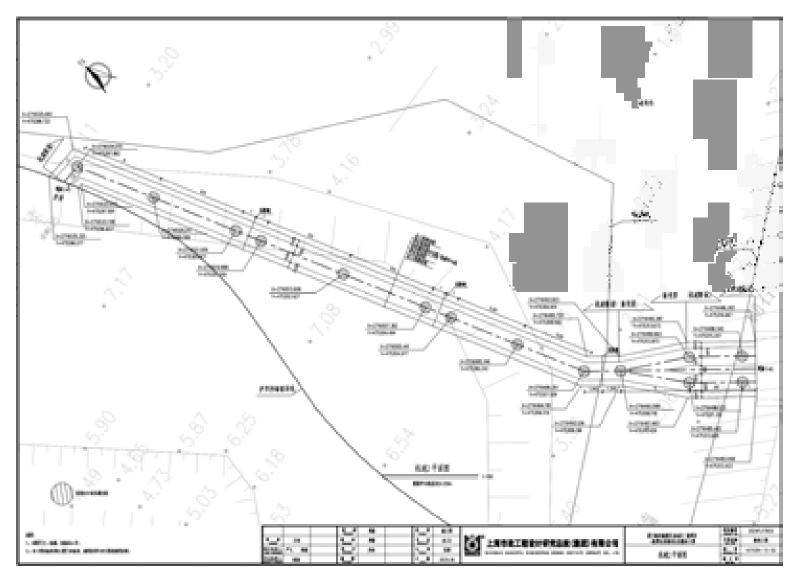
栈道平面布置图 (滨海东大道北侧)
